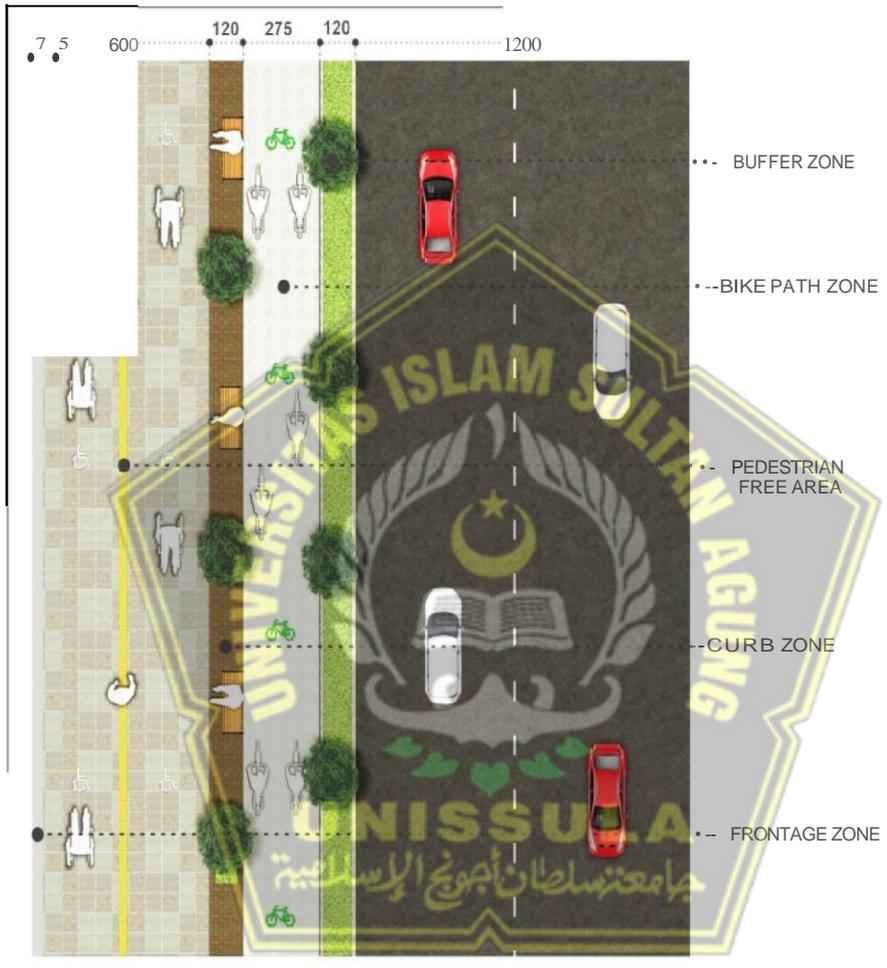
Denah Lay Out Kawdsan RTH Publik
